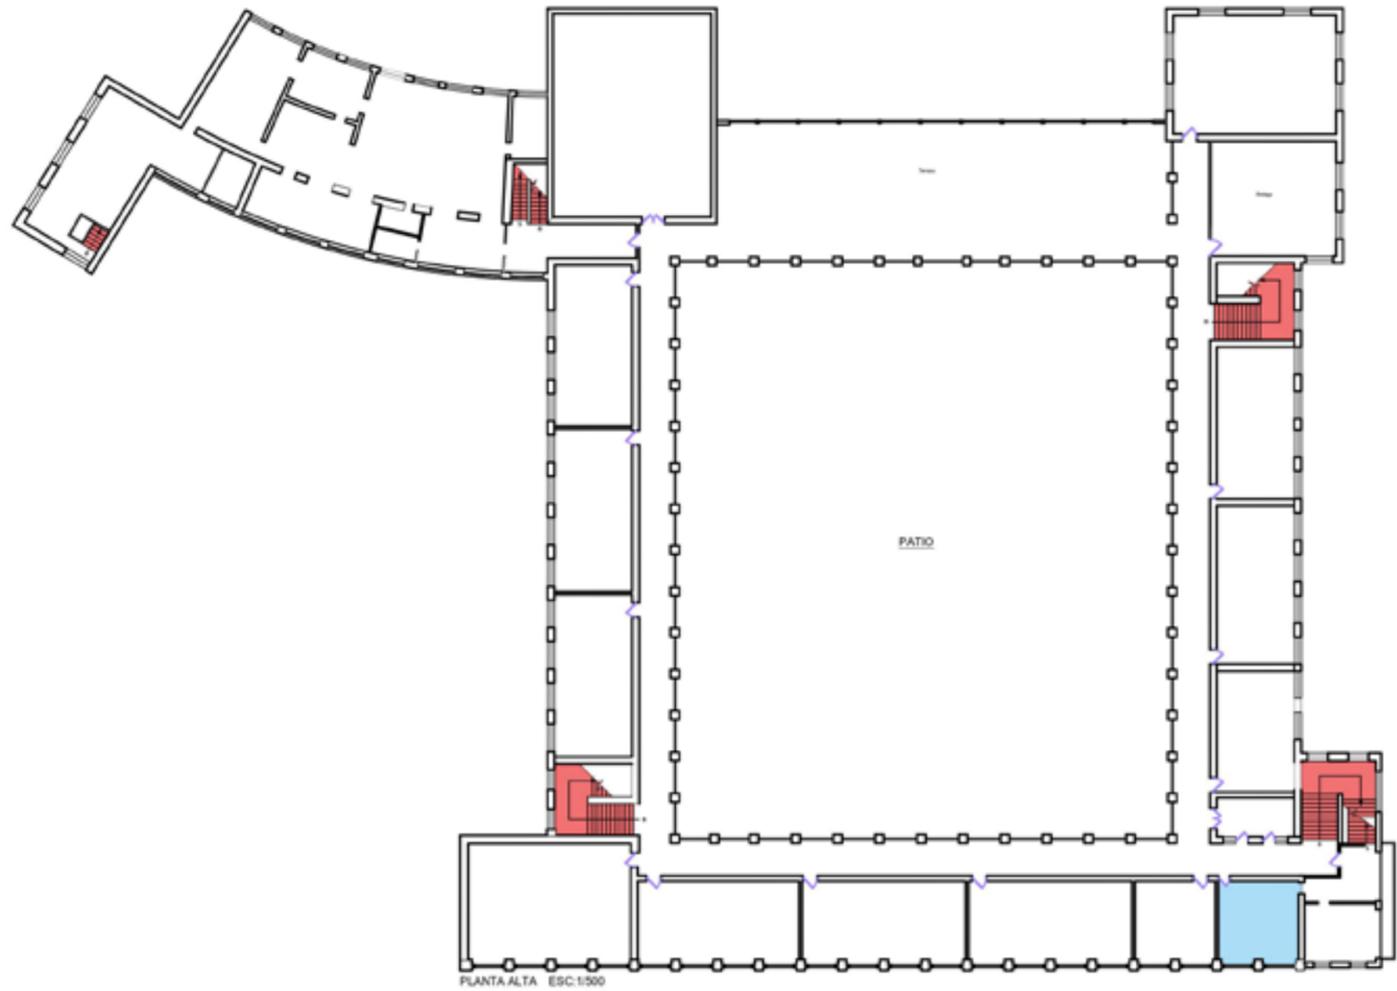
Condicionamiento marcadas en la planta alta. Elaboración Propia (2021)
